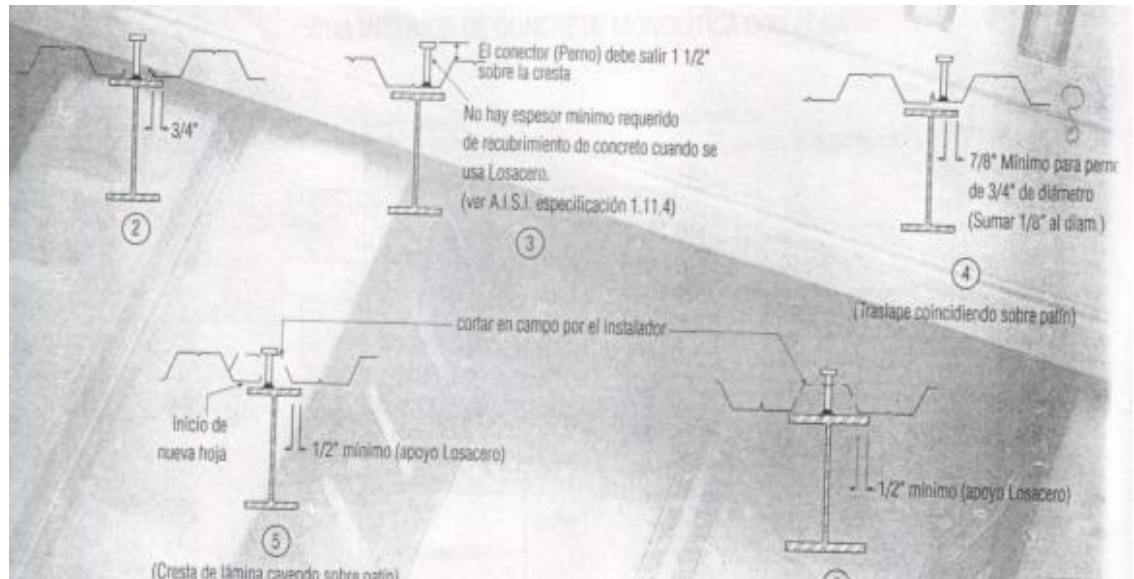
Detalle de traslapes utilizando cuando la losacero se instala colocando conectores.
